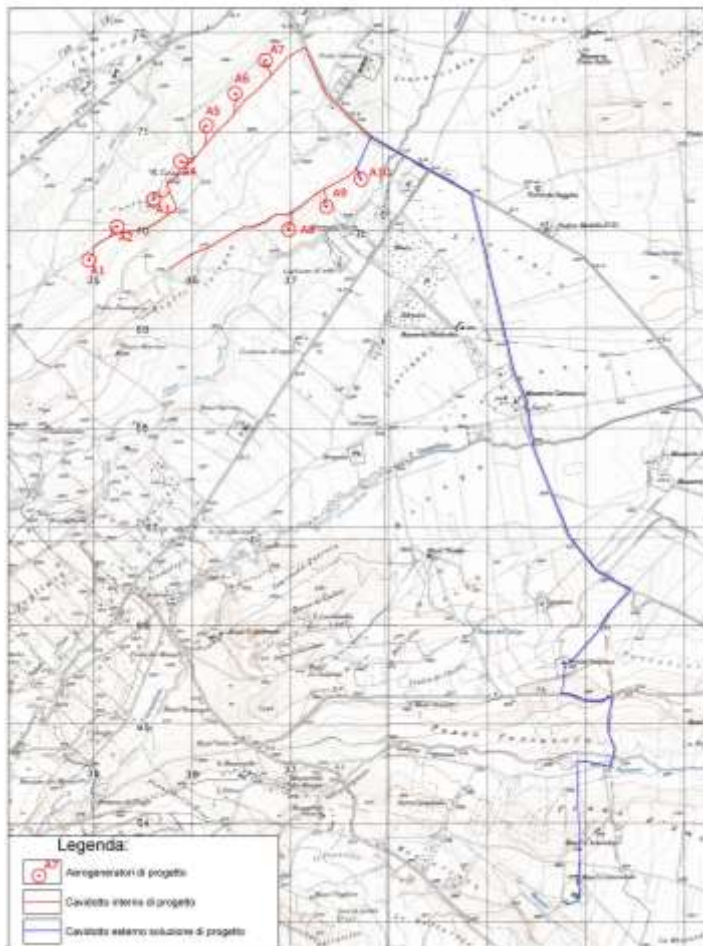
layout d'impianto con soluzione di progetto per il collegamento MT (in rosso il cavidotto interno, in blu il cavidotto esterno)
